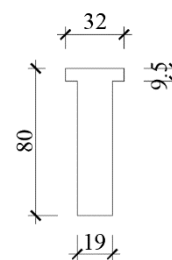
Dimensões do conector *stud bolt*, em mm.
